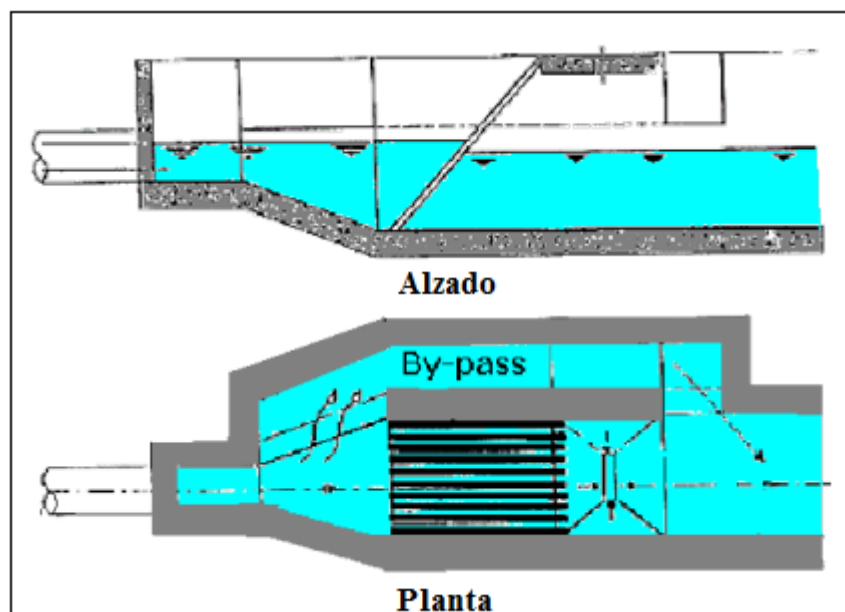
Esquema en planta de un sistema de rejillas y del canal de by-pass asociado al mismo.
